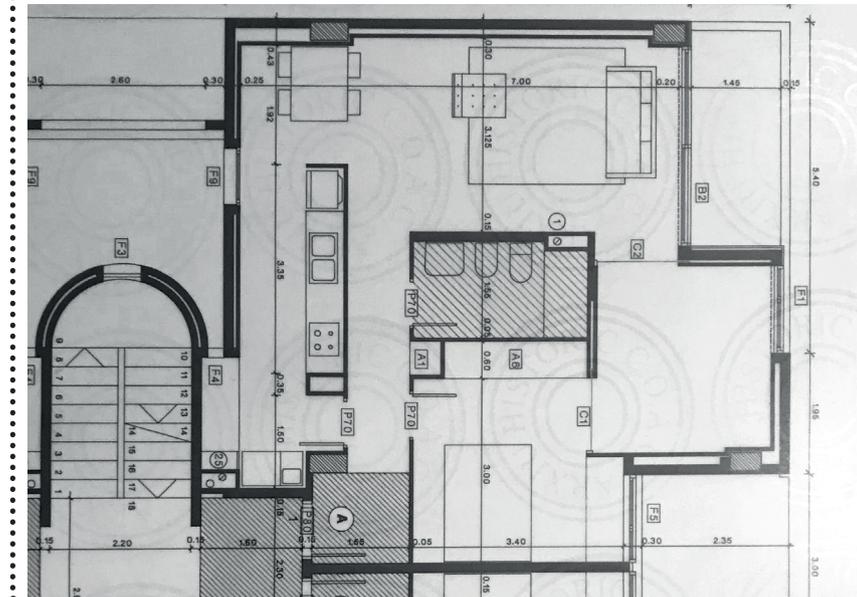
Planta vivienda-unidad en el Barrio de las Bóvilas (1999) de Lluís Nadal.
